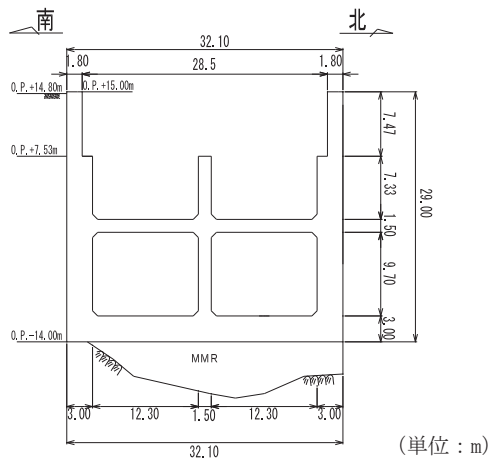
第 3 号機海水ポンプ室断面図 (B-B 断面)
